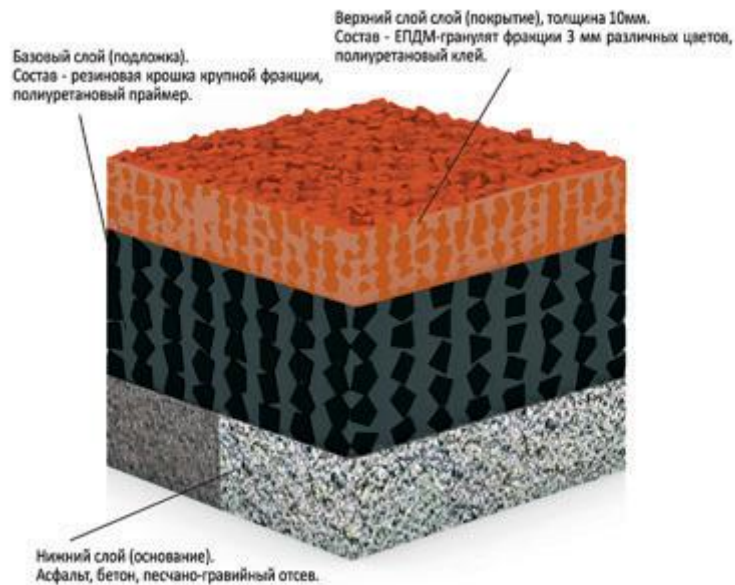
Монолитное бесшовное резиновое покрытие из резиновой крошки
